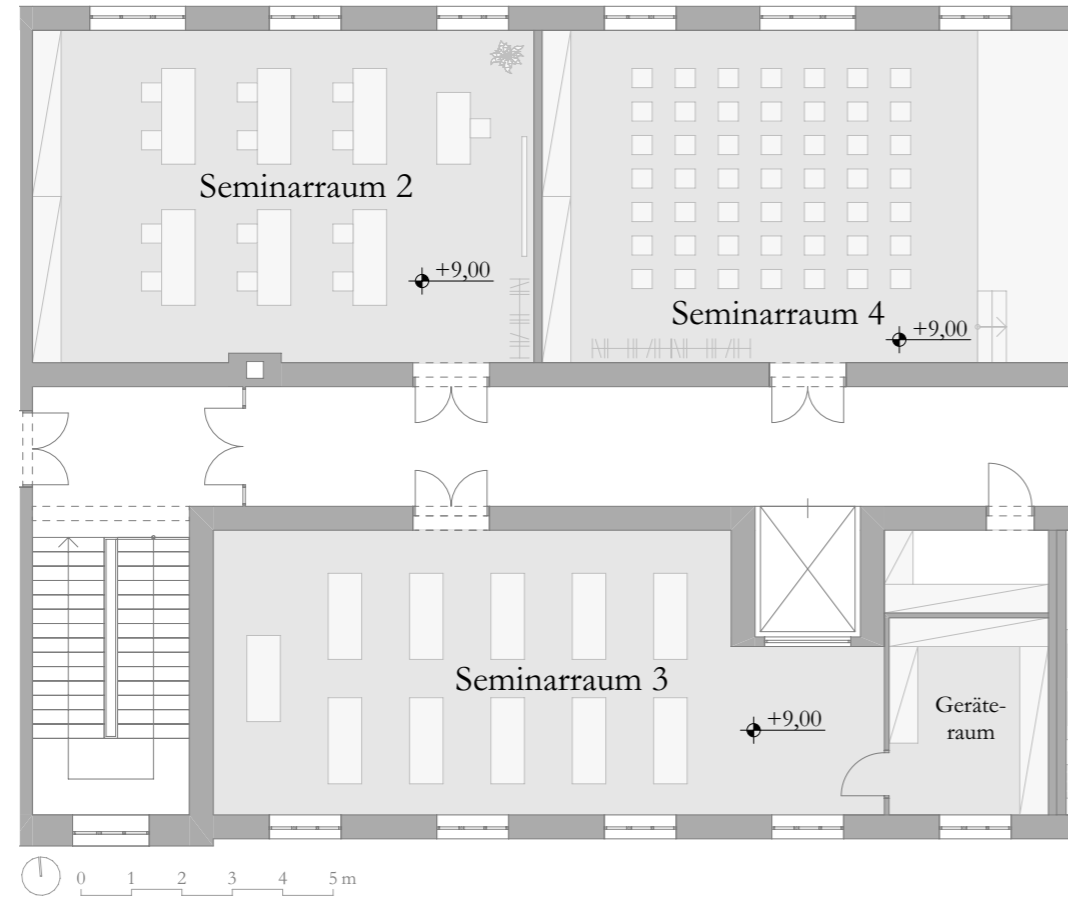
Grundriss Dachgeschoss (Detail Seminarräume) M 1:150
